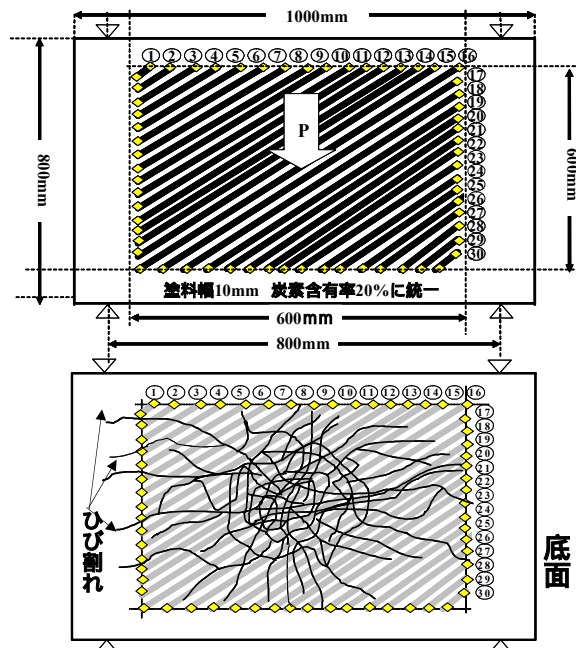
床版試験体塗装方法と測定時のひび割れ
